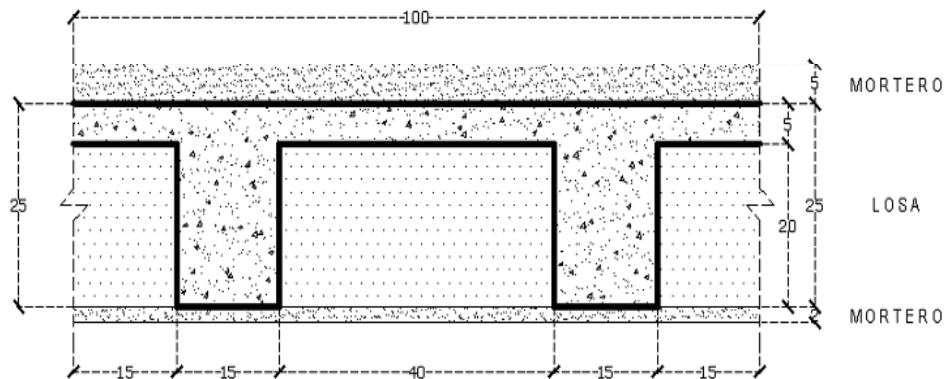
Perfil de losa “encasetonada” de azotea.
